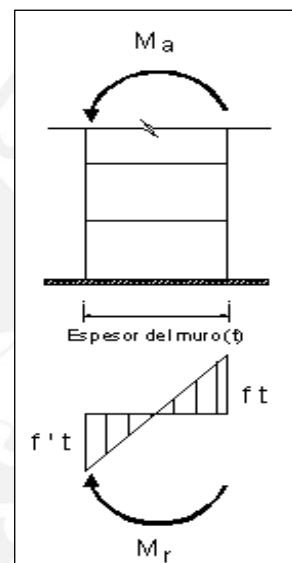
Momento resistente M_r en un muro de albañilería
